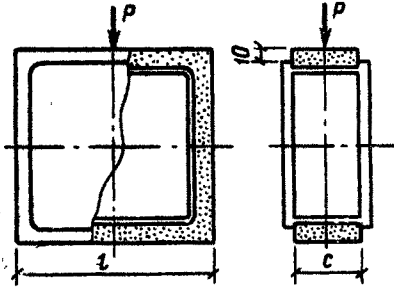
Схема испытания стеклянного пустотелого блока на сжатие
